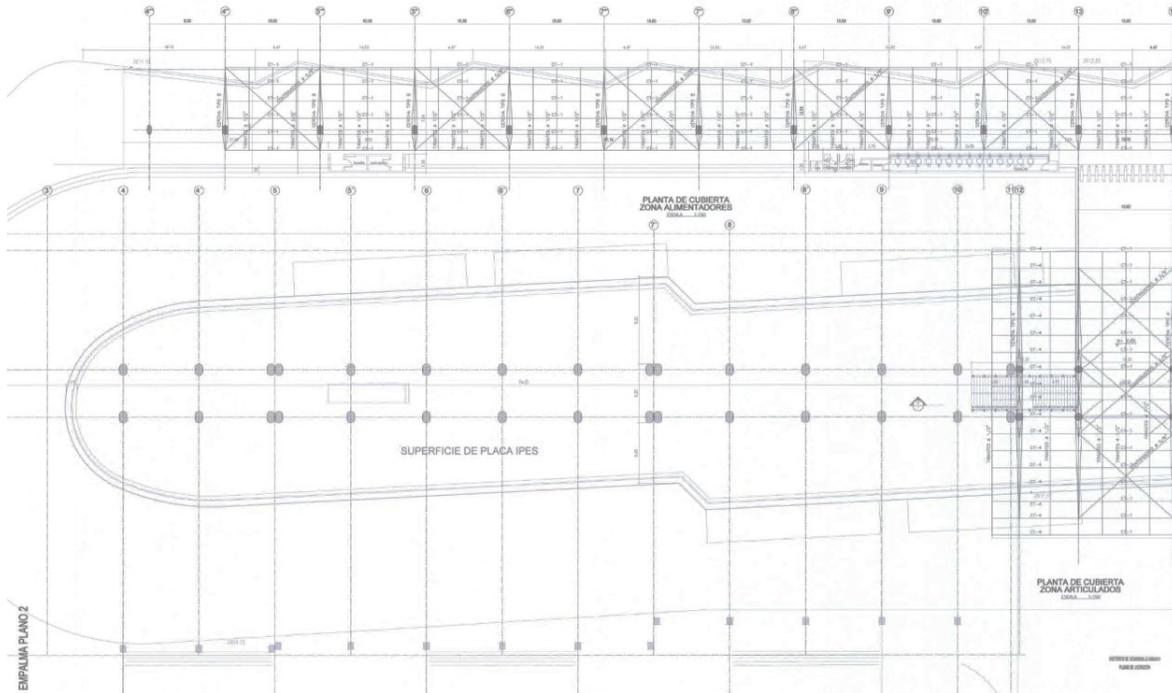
Planta de cubierta metálica de articulados y alimentadores.
